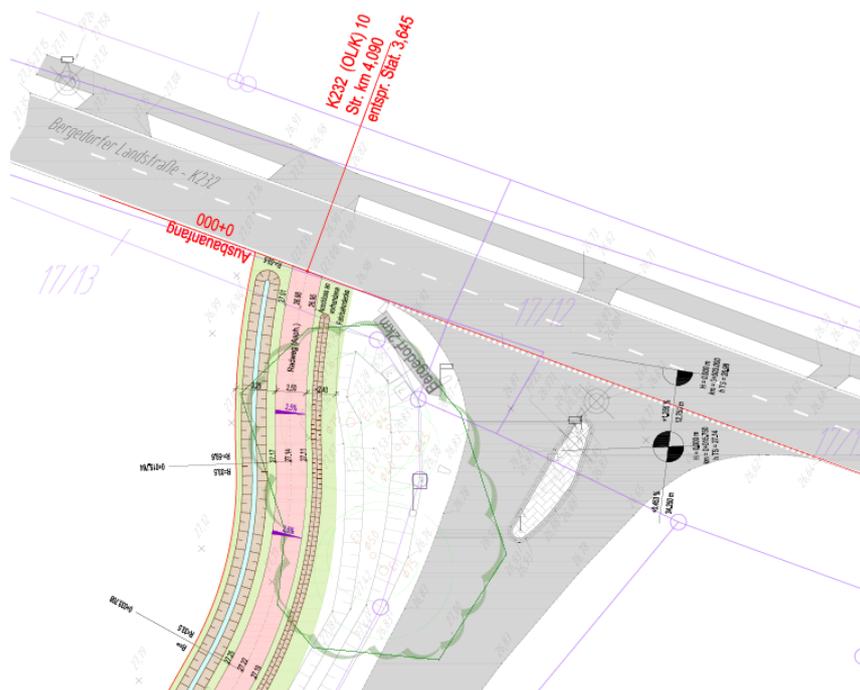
Lageplanausschnitt Anschluss Radweg an die Bergedorfer Landstraße – K232
